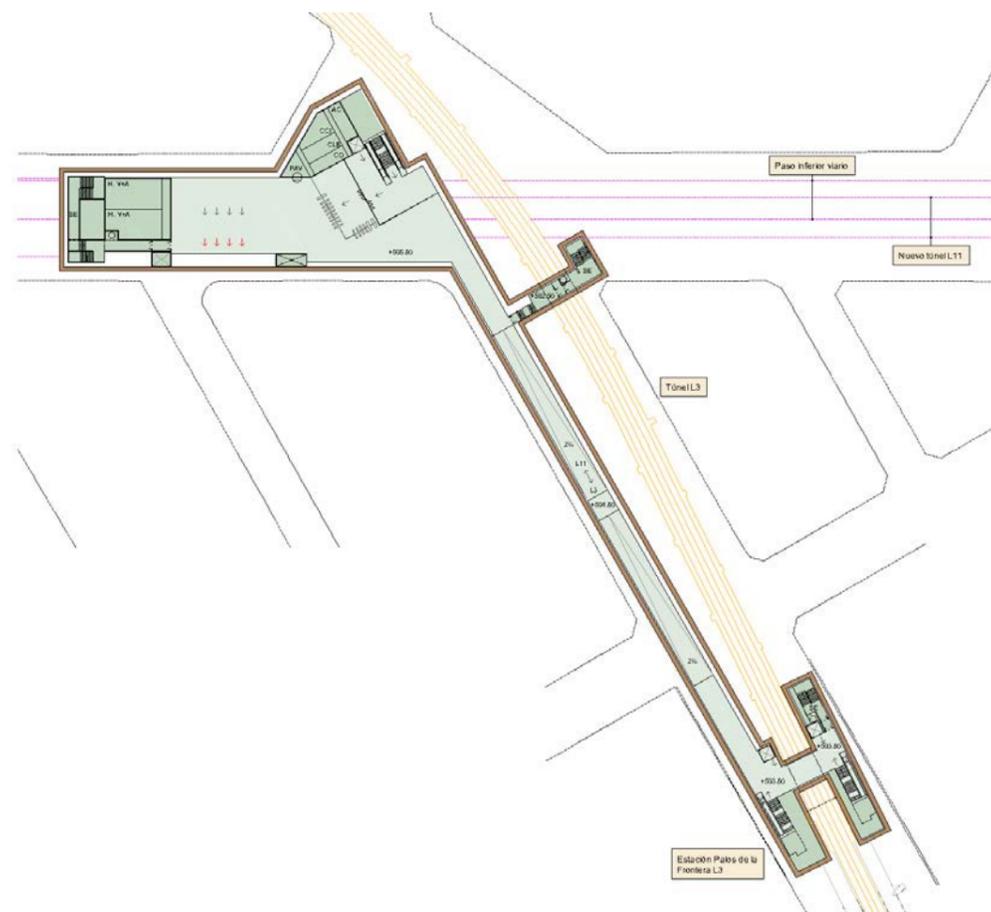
Planta vestíbulo de la estación Palos de la Frontera L11, Alternativa 2.
